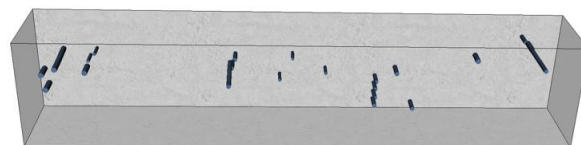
Vista 3D de acero de Viga (FS65 y FS66)
